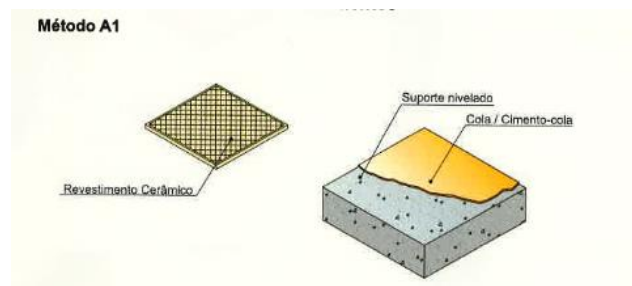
Aplicação de cimento-cola/cola diretamente sobre o suporte [3]
